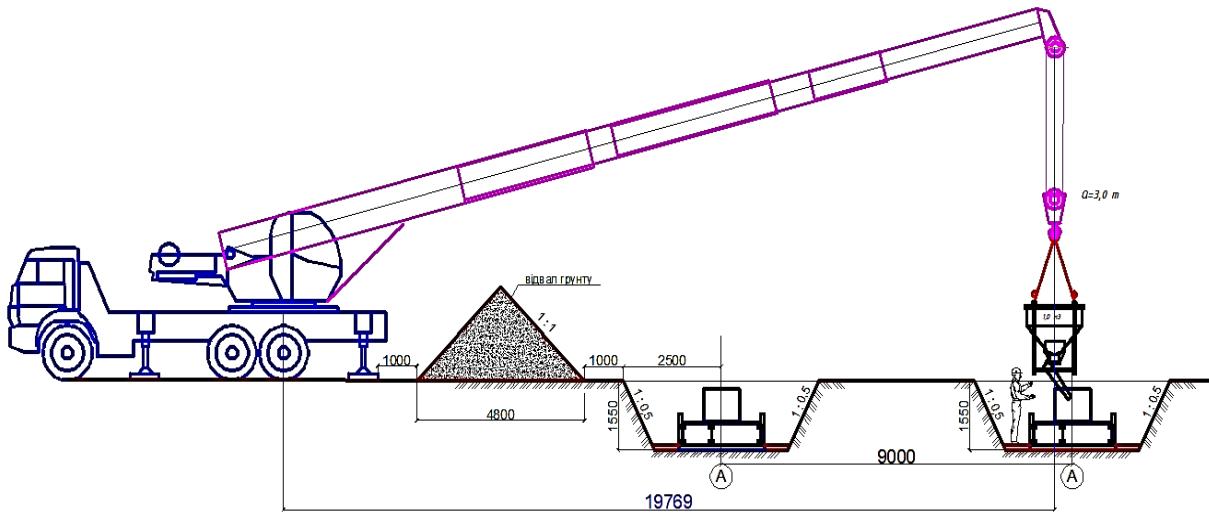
Схема вкладання бетонної суміші в опалубку краном
